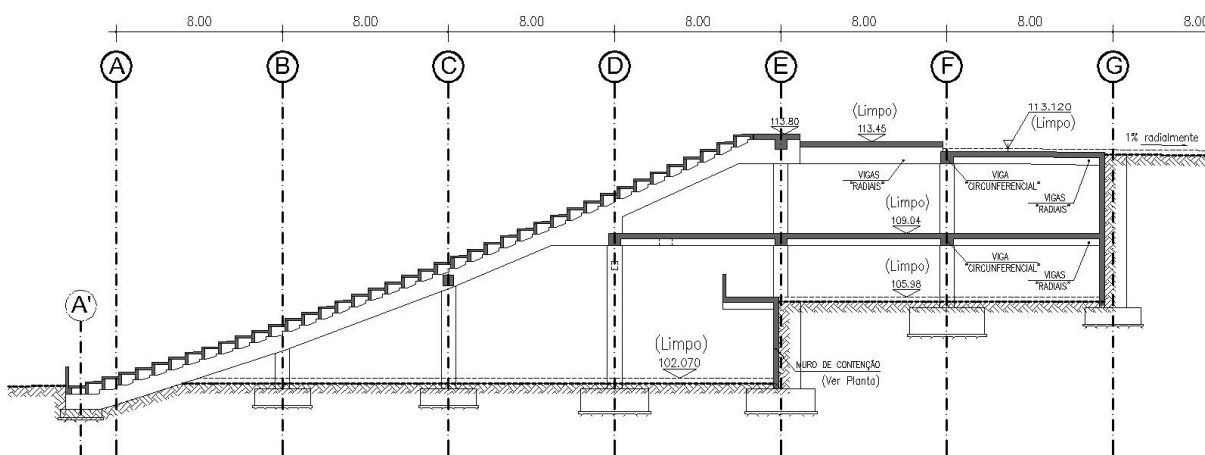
Pórtico principal tipo da bancada norte (adaptado de Marques, 2009).
